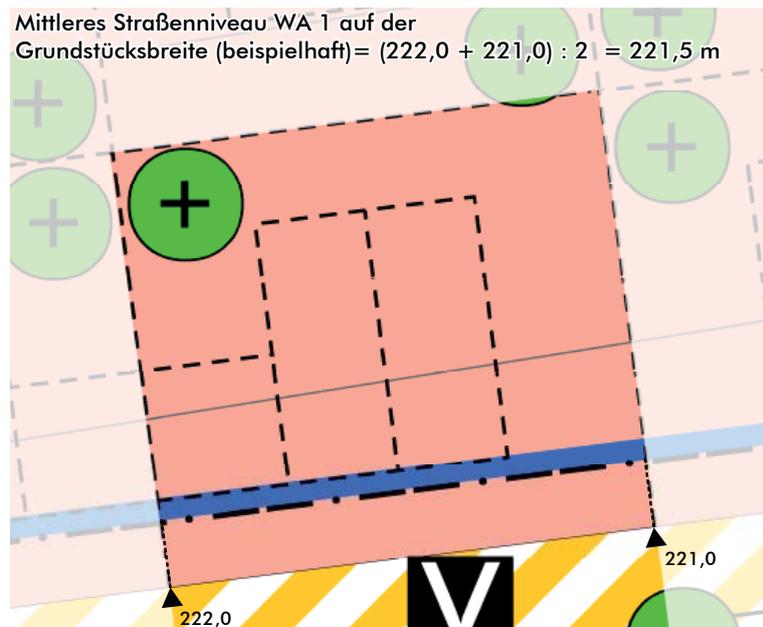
Schemagrundriss Unterer Bezugspunkt WH und GH im WA 1, unmaßstäblich
